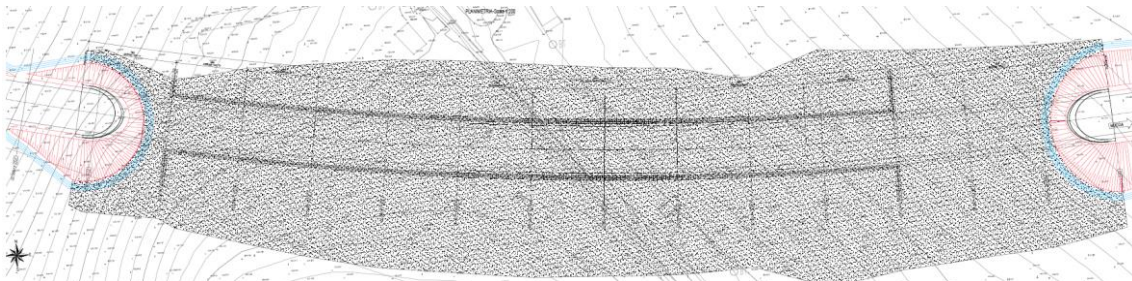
Galleria Artificiale Mistranello - Stralcio Planimetrico
